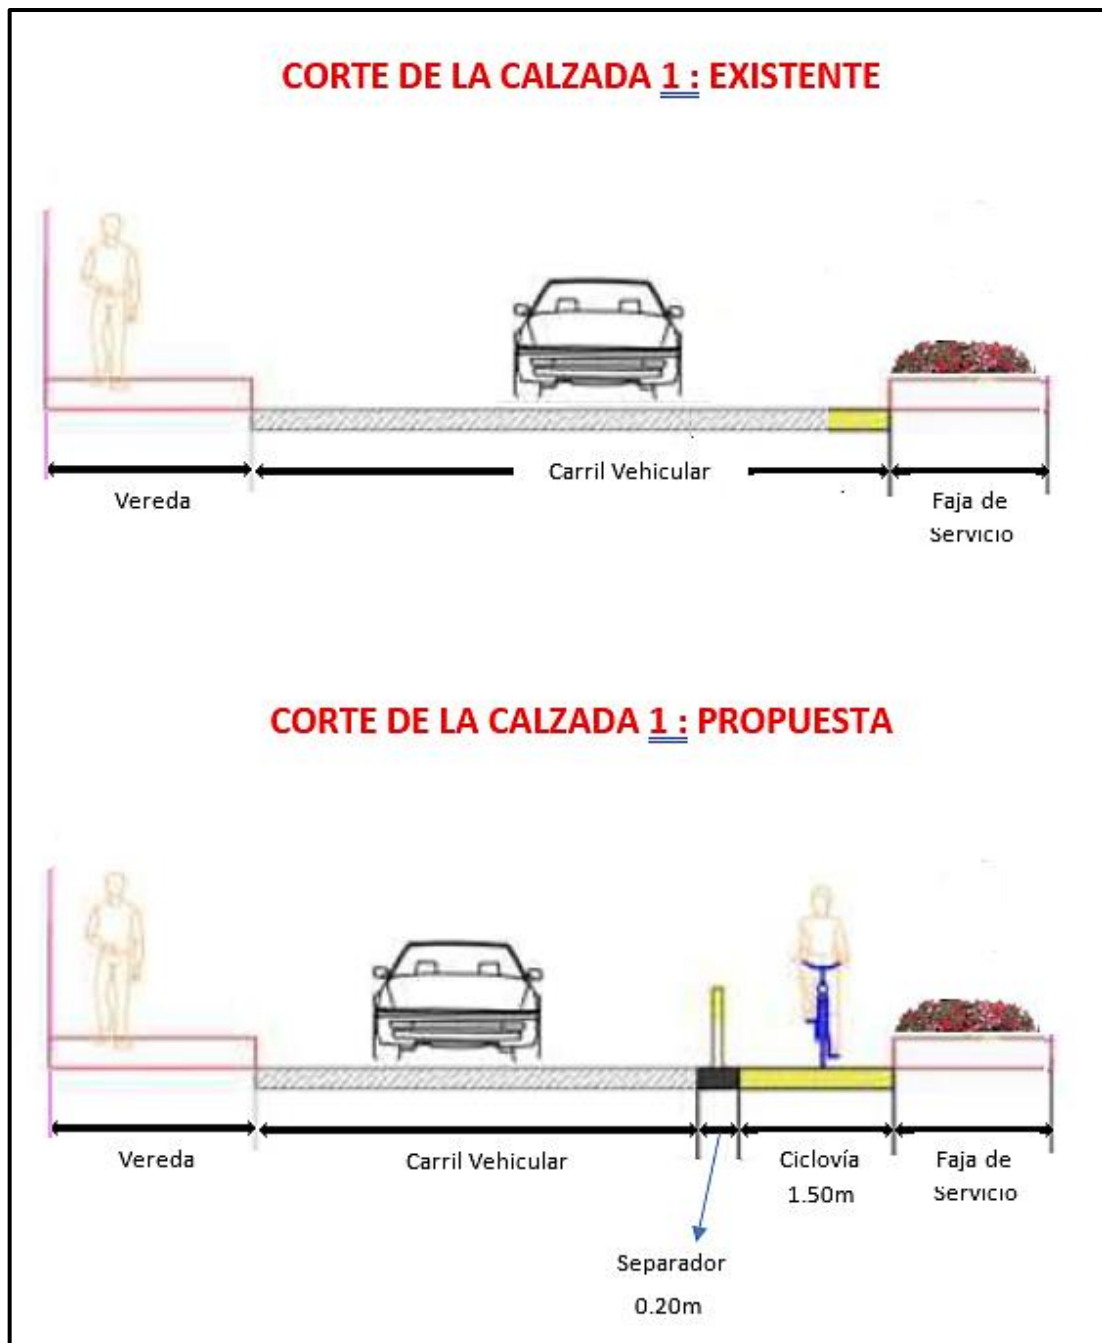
Se muestra la sección transversal existente de la calzada 1 y la sección transversal propuesta para la implementación de una ciclovia y un separador de tránsito.
